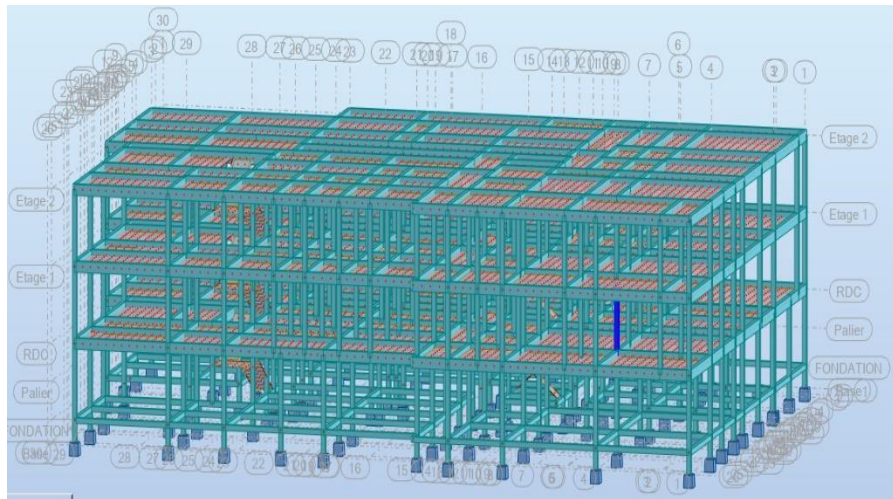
Poteau le plus chargé du 1^{er} étage en elevation
